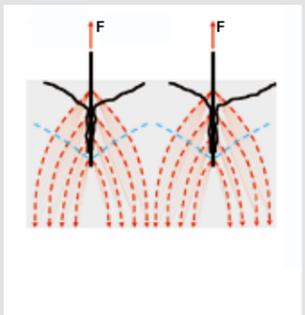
Lastweiterleitung eingemörtelter Stäbe (Spieth, 2002) ohne Anschlussbewehrung
